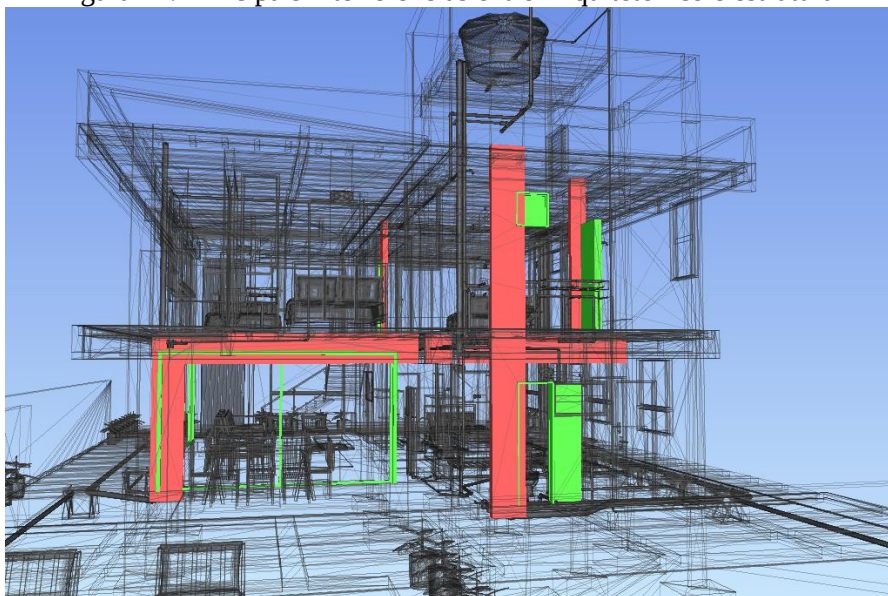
Principais interferências entre estrutural e hidrossanitário.
